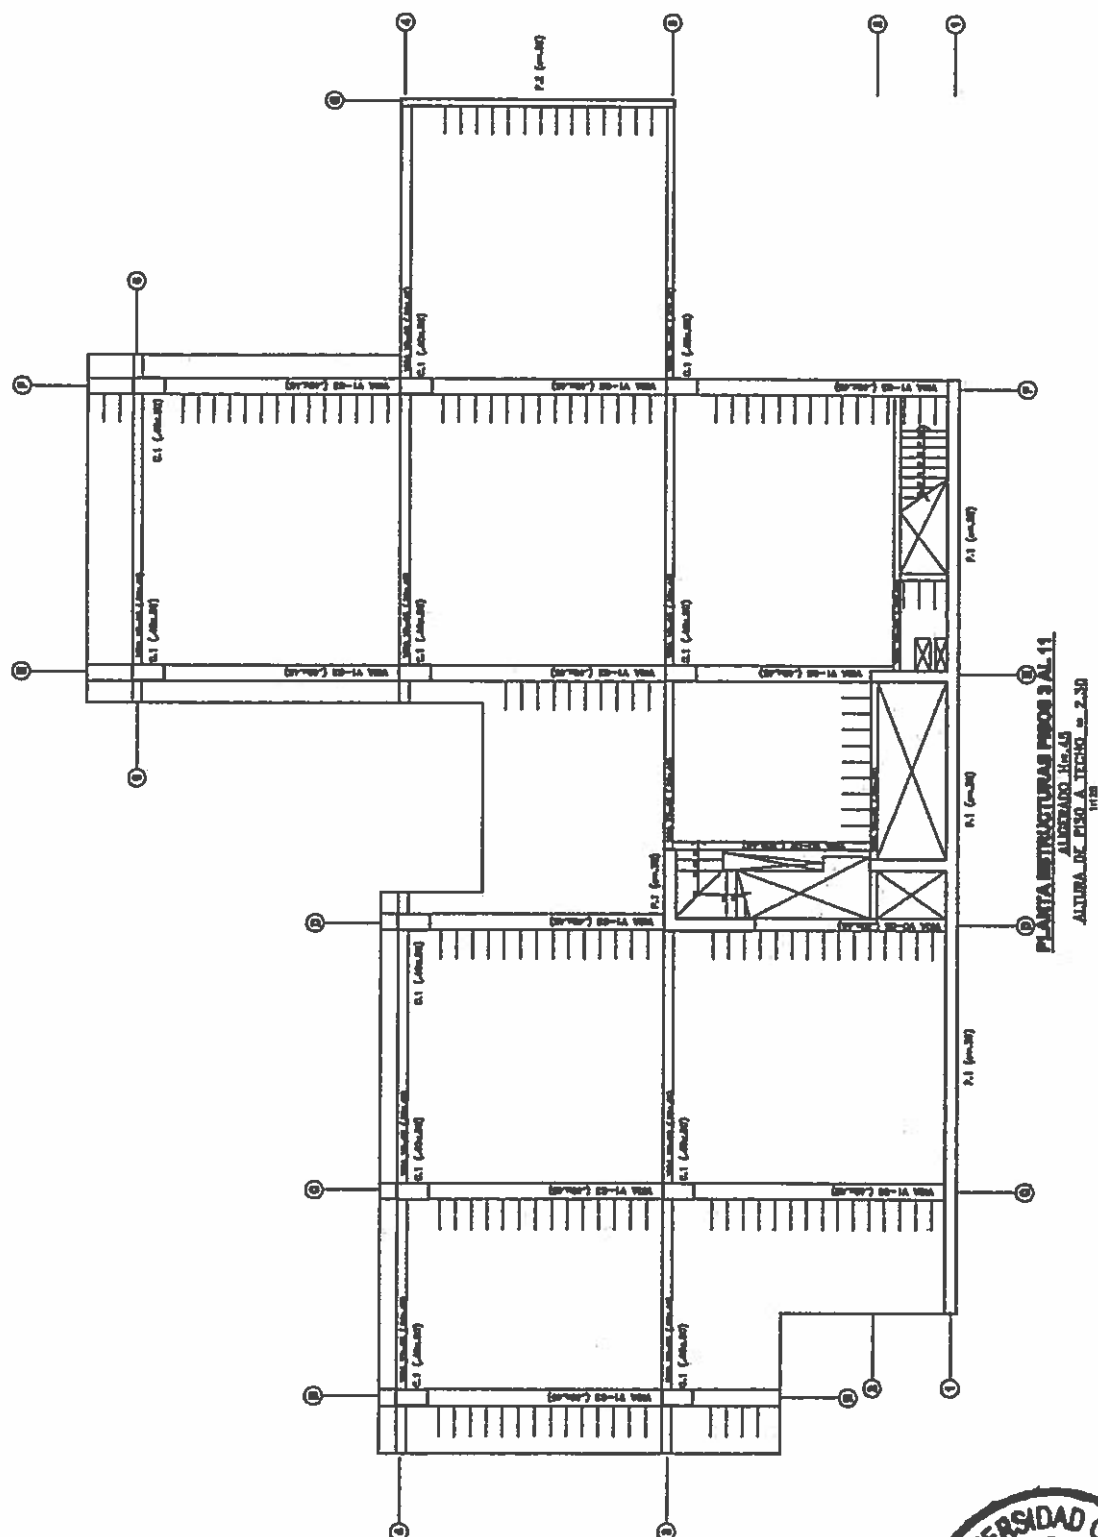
Planta de estructura típica de los pisos del 3 al 11.
